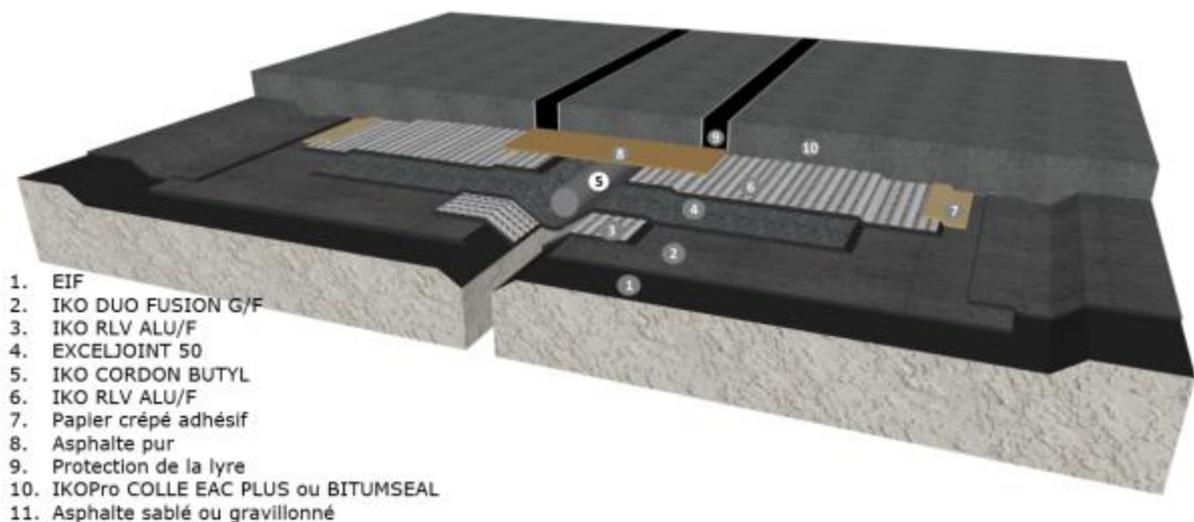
Joint plat raccordé à une étanchéité mixte (feuille + asphalte)
